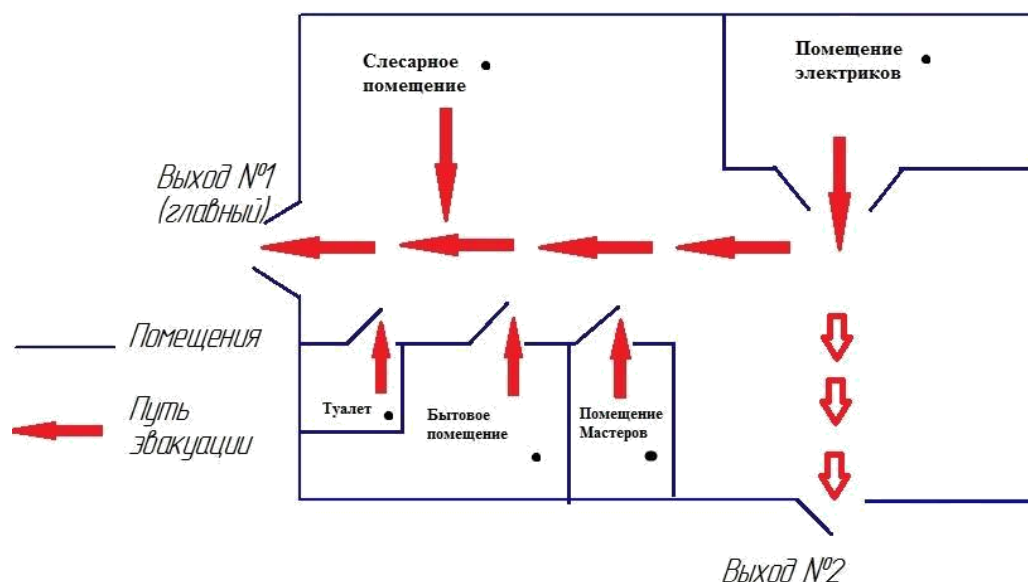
План эвакуации из сварочного цеха ЦРП
